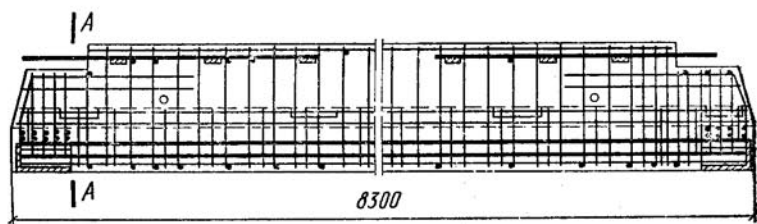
Армирование ригеля поперечной рамы пролетом 9 м
